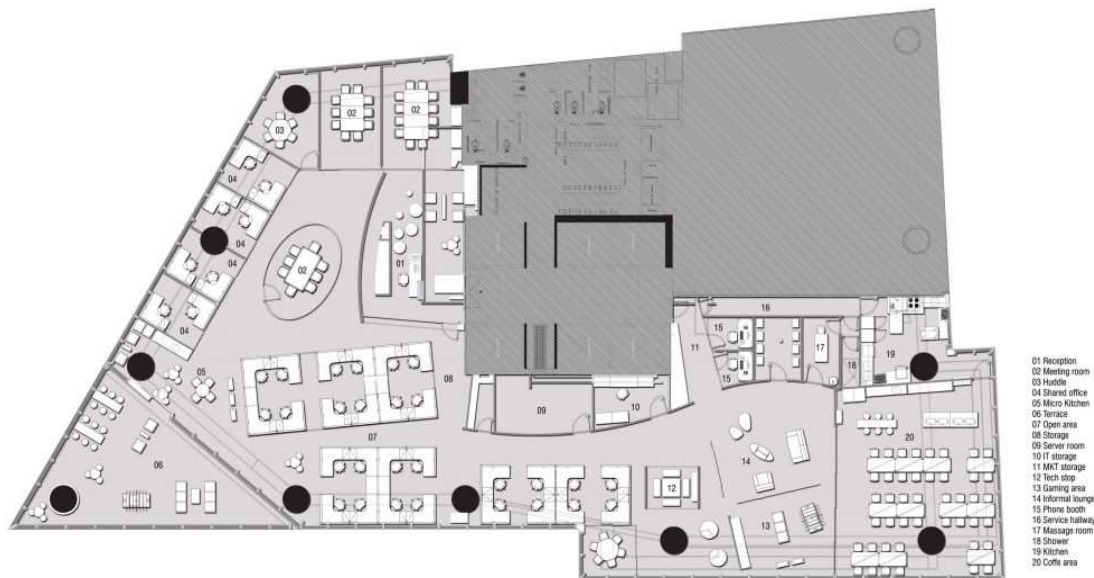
Planta 2 / Fuente: ArchDaily Google - México
